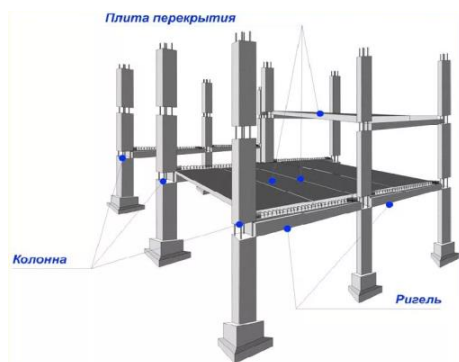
Сборно-монолитная железобетонная рамная конструкция
